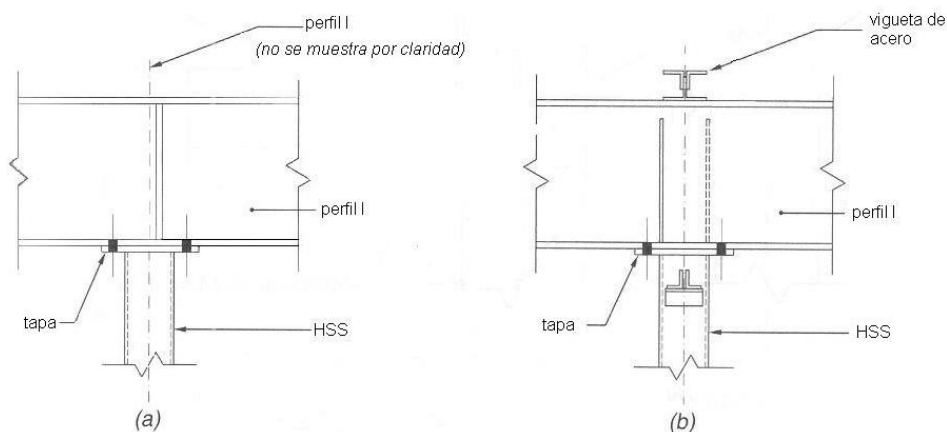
Conexiones a momento con vigas continuas bajo columnas HSS (manual AISC, 2010)
